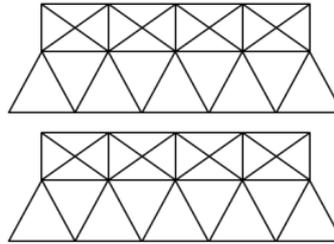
Esquema en planta de la disposición de las láminas 1:1
